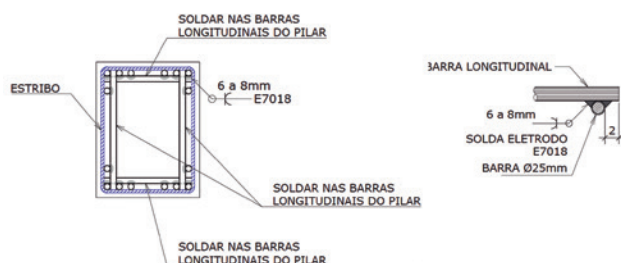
detalhe de barra de ancoragem soldada
